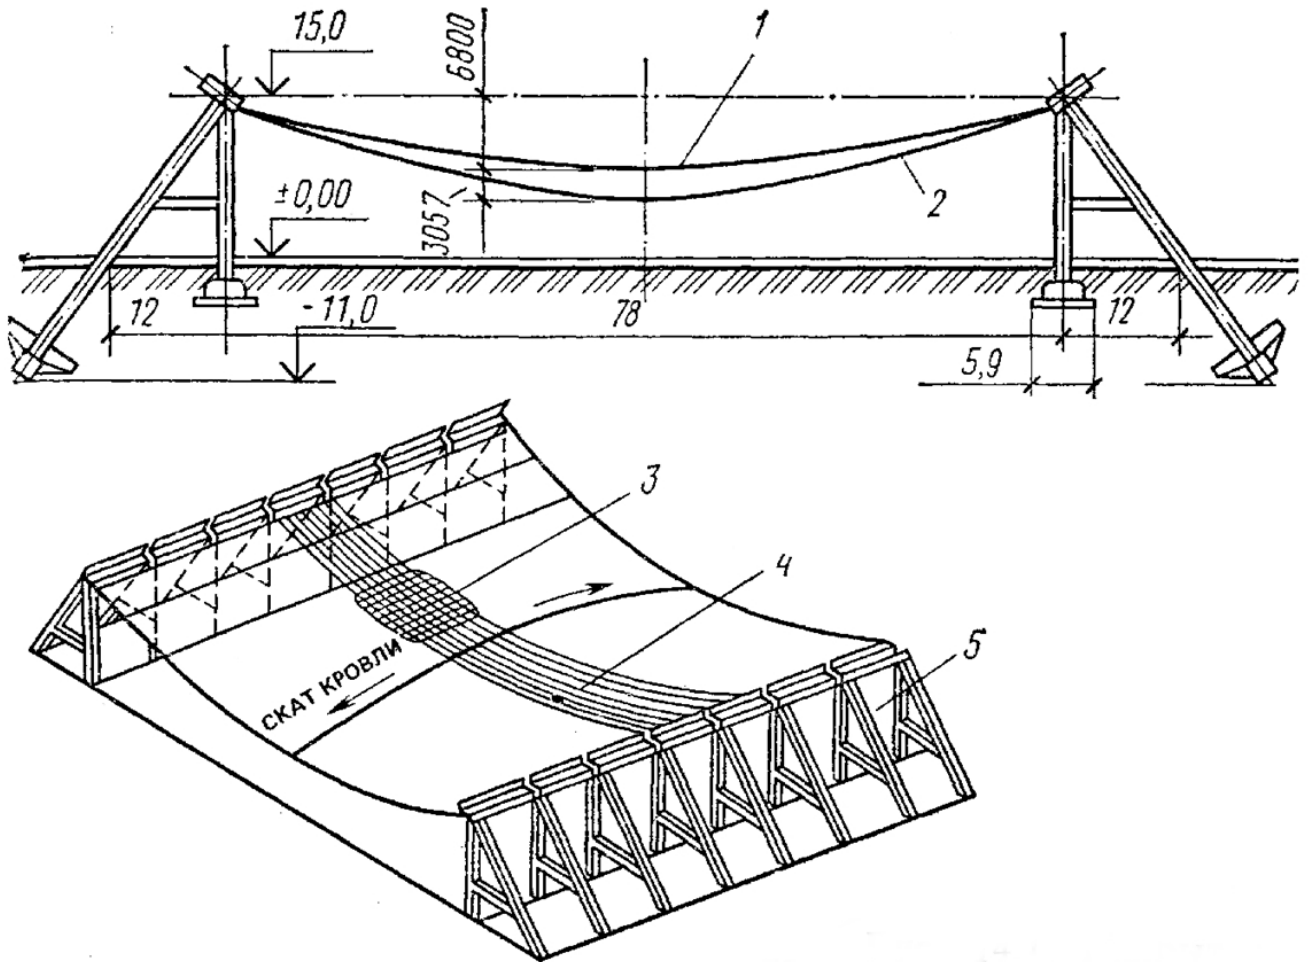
Покрытие гаража в Красноярске: 1, 2, 4 – несущие стержни > 40 мм через 1,5 м; 3- железобетонные плиты; 5 – опорная конструкция
